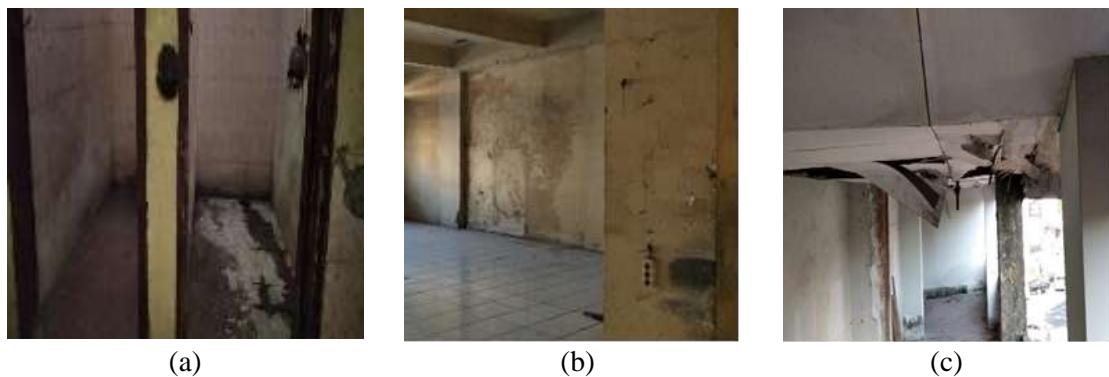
Kerusakan bangunan lantai 1 bagian (a) Lantai, (b) dinding, (c) langit-langit
